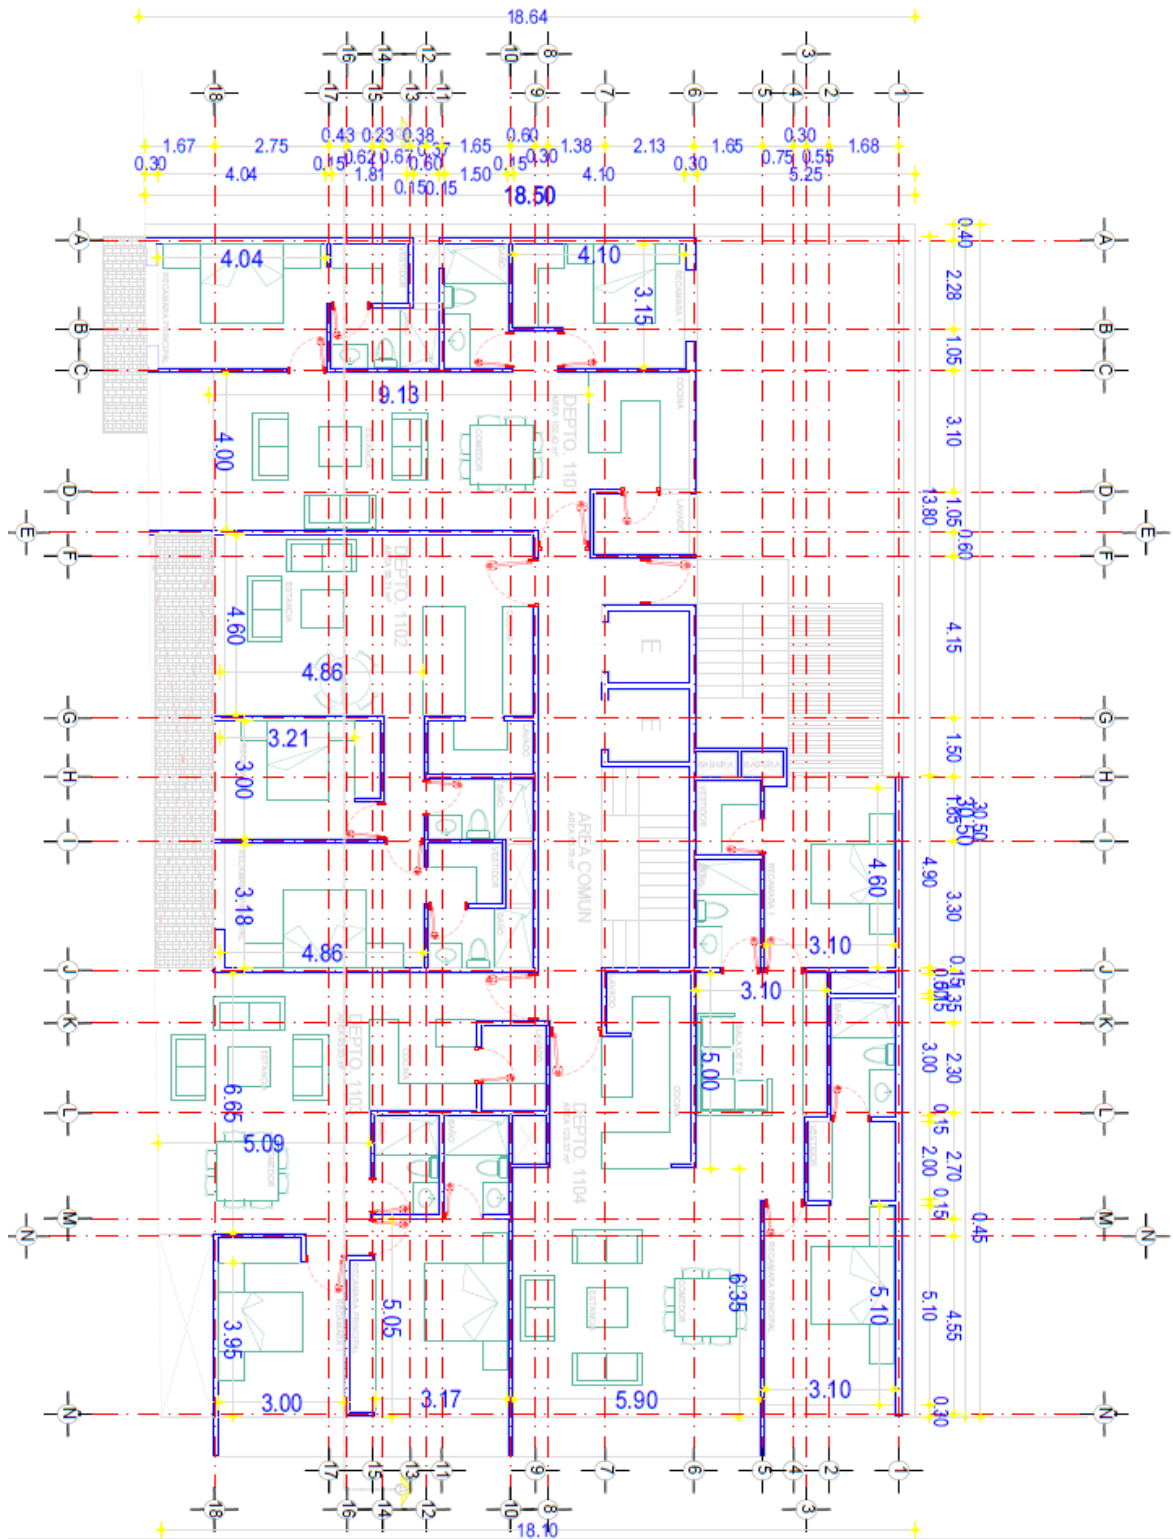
D.- PLANTA ARQUITECTÓNICA TIPO 2, NIVEL 4 -13
